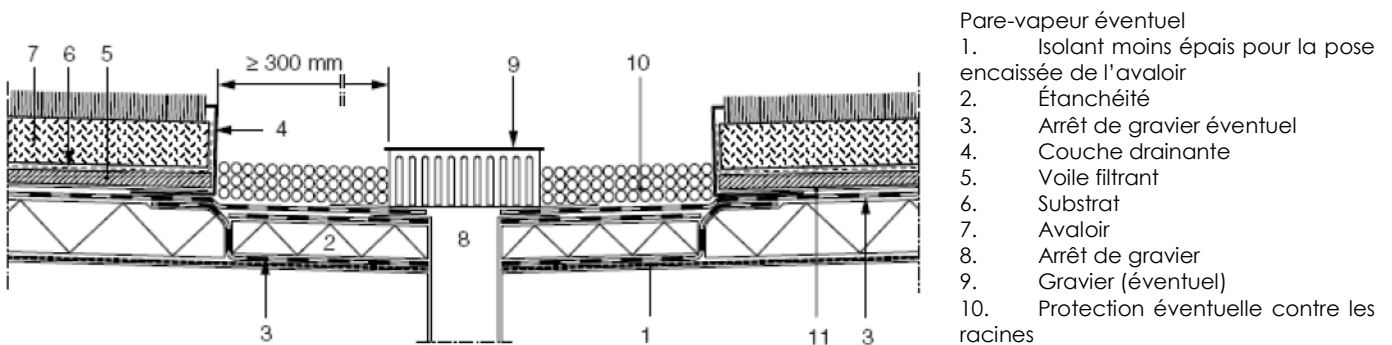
Détails de toiture : avaloir accessible d'une toiture végétalisée
